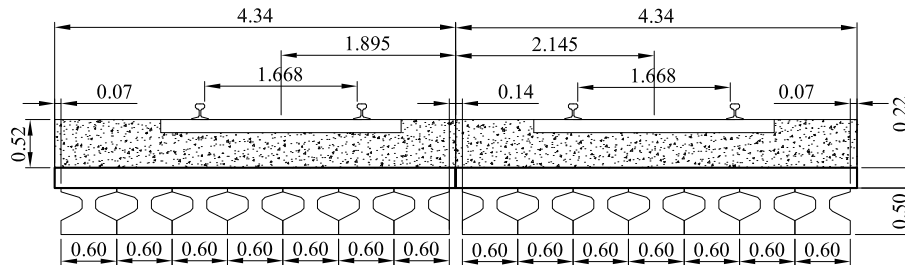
Sección transversal recta del tablero central del puente Vinival.
